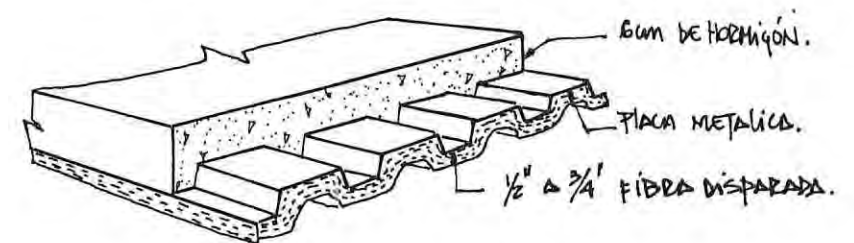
Techo y piso con protección de fibra disparada con pistola.
